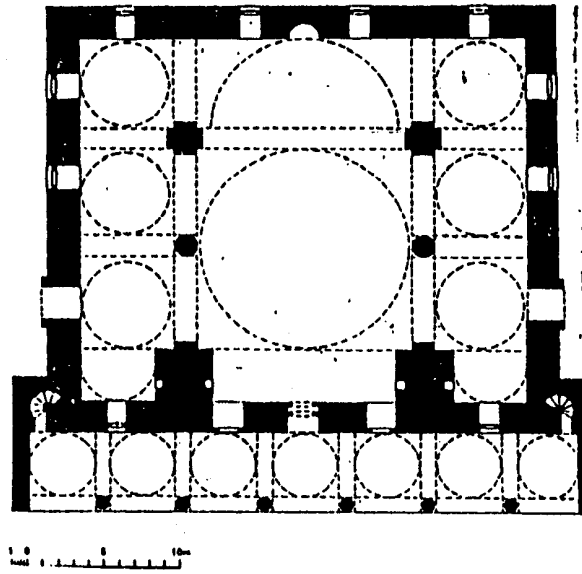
مسقط أفقي لجامع محرمة سلطان باسكدار
